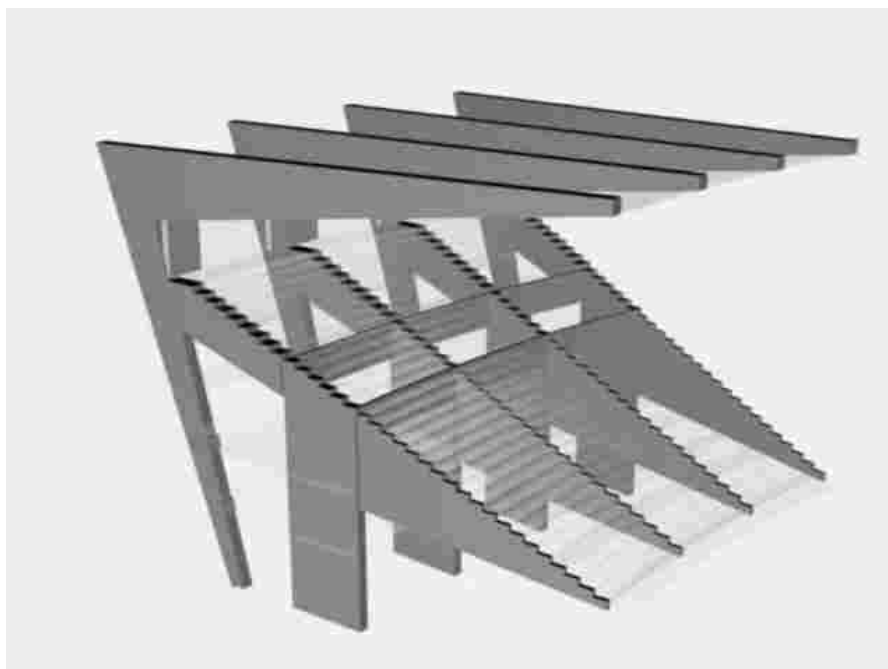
Croquis do projeto das estruturas principais dos demais setores do Mineirão, após a alteração necessária da viga da arquibancada
